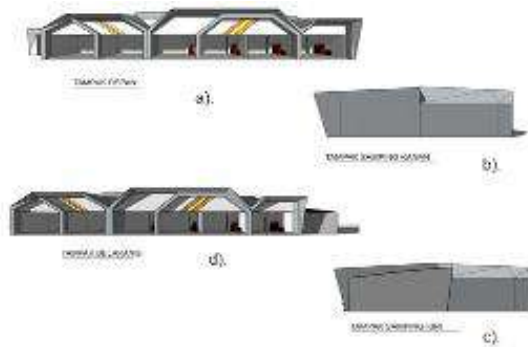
a). Tampak Depan b). Tampak Samping Kanan c). Tampak Samping Kiri d). Tampak Belakang Gedung Utama
